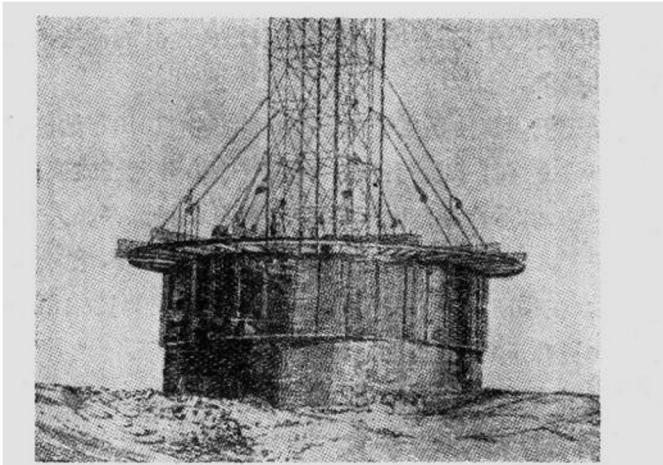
修建圓錐形钢筋混凝土烟囱用的金属移置模板
